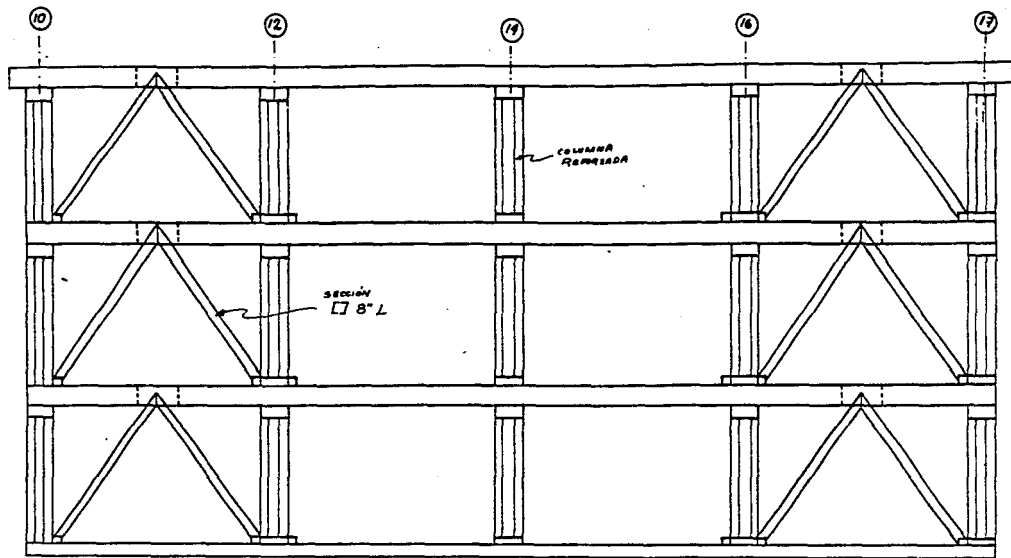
ELEVACIÓN EDIFICIO 4 CRUJÍAS
